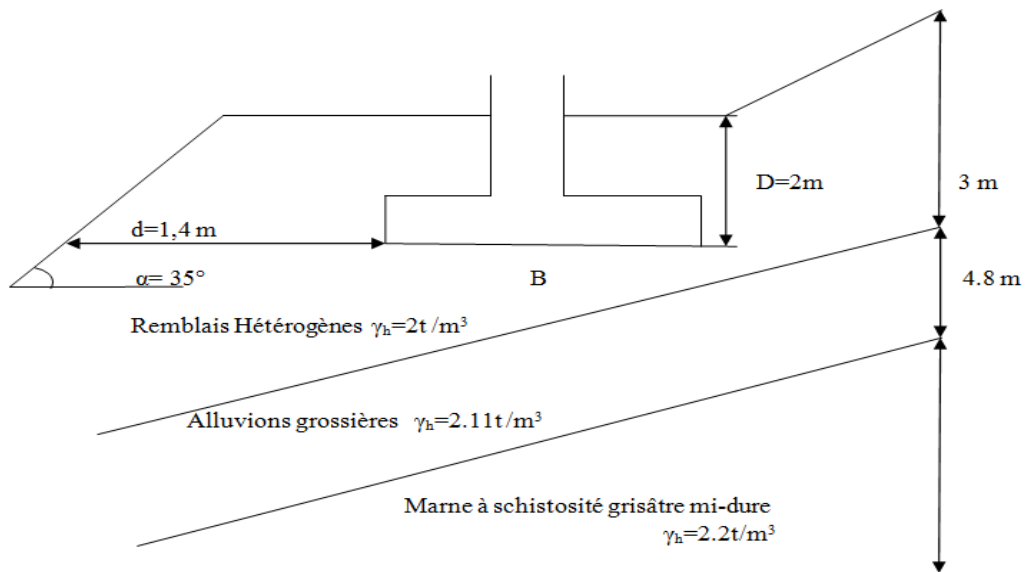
coupe sur le sol sous la fondation (SP2).
